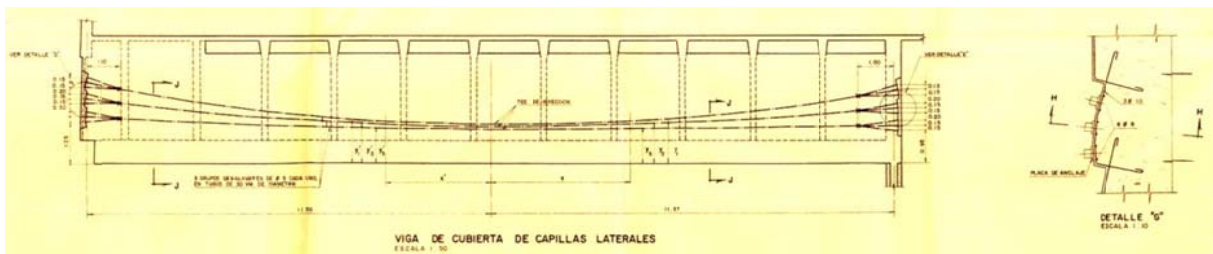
Postesado cubierta capillas laterales. (Nadal, J. 1960)
